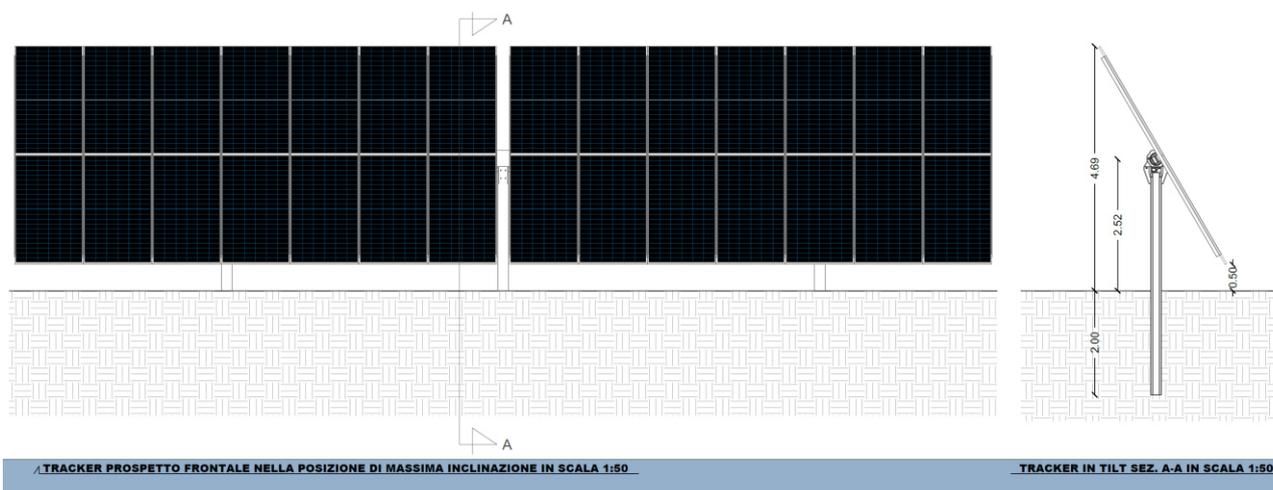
Tracker 2P in posizione di massima inclinazione - Vista Longitudinale e Sezione Trasversale
